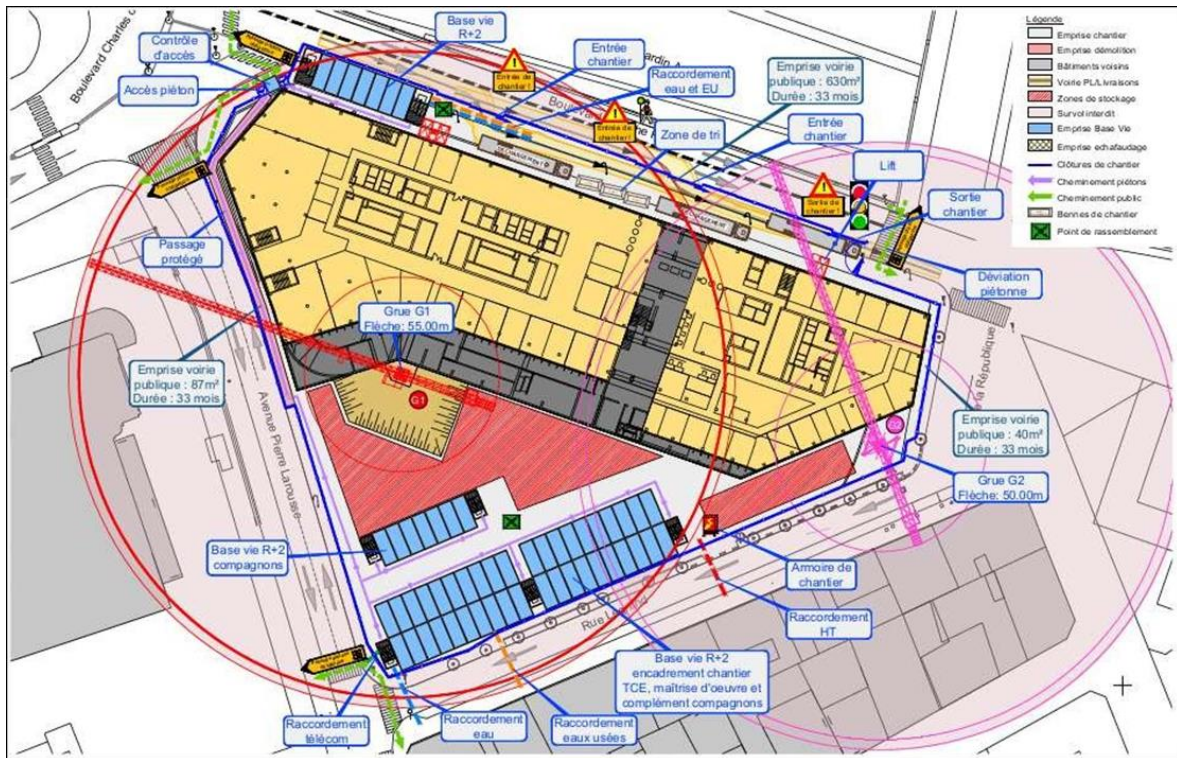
Plan d'Installation de chantier : phase construction (Source : Eiffage, 2022)
